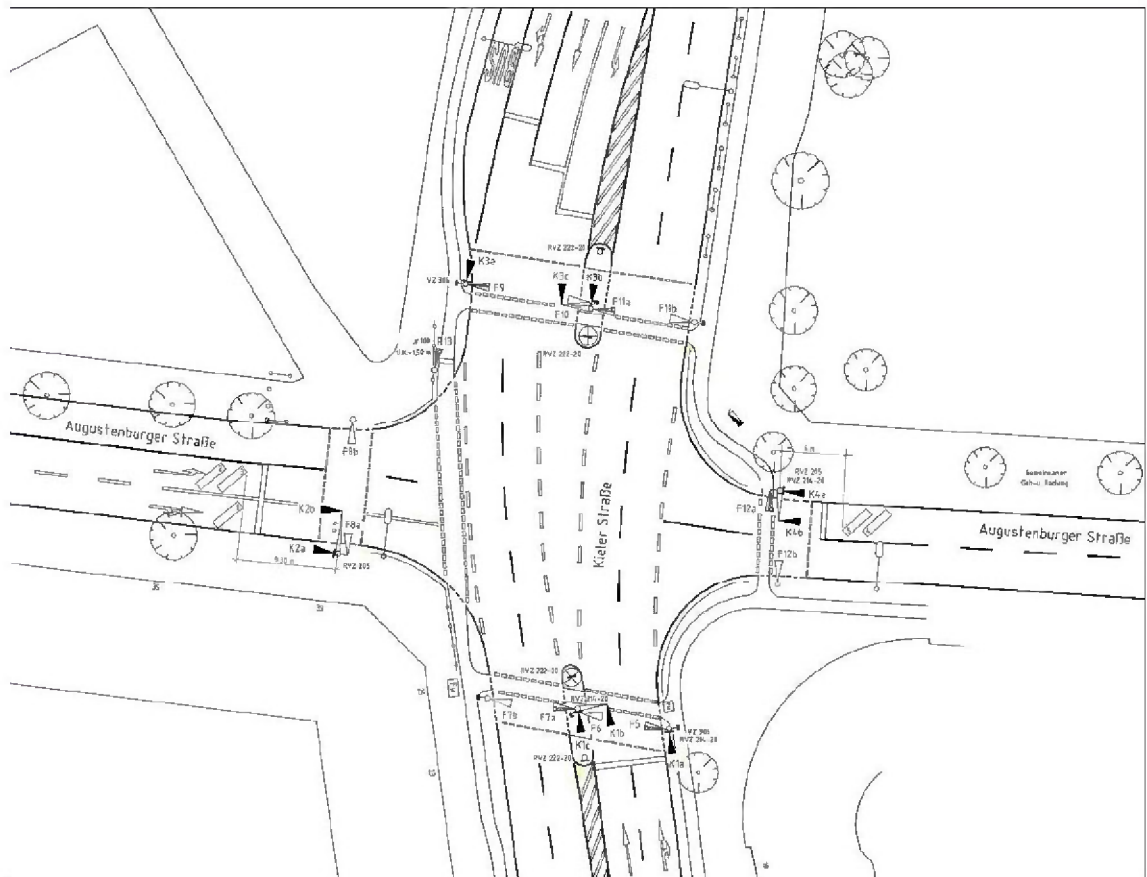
Signallageplan Kieler Straße/Augustenburger Straße – Bestand (02/621-04-02/01)
